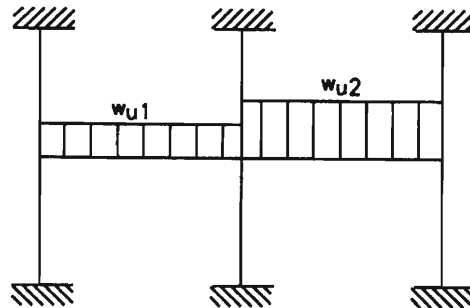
Modelo para el cálculo de los momentos en columnas
